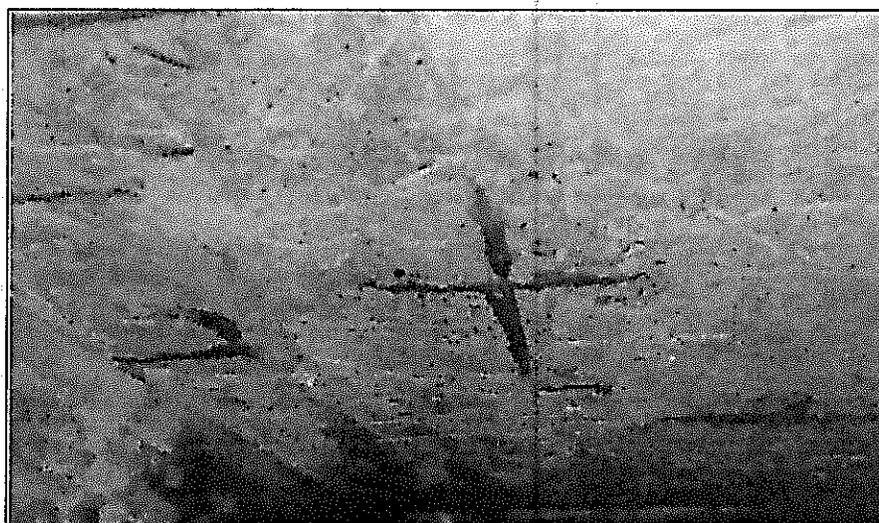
Exposición del acero de refuerzo en la losa de cubierta zona 1.
